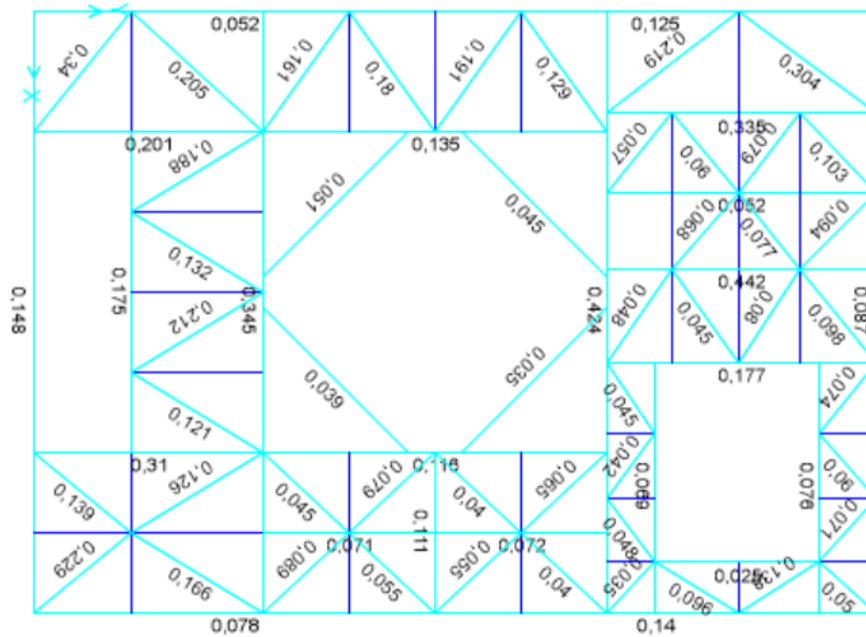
Factores de utilización vista en elevación 8.42 [m] sobre nivel de terreno.
